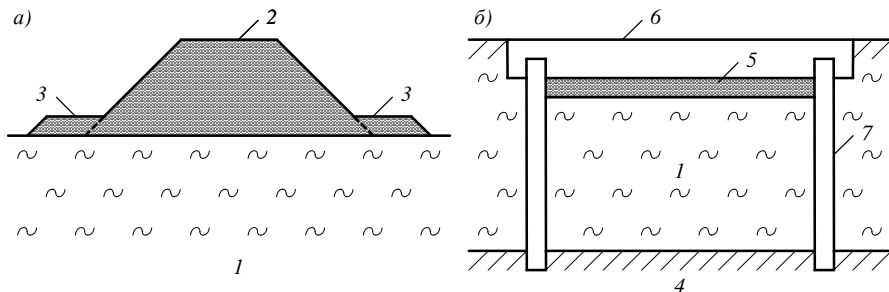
Схема закріплення основ, складених слабкими ґрунтами:
